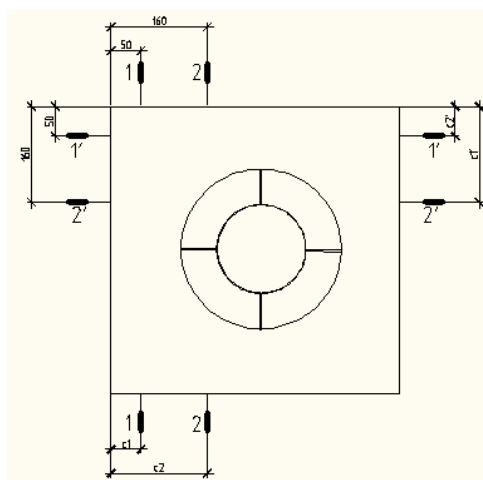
Схема к расчету армирования плитной части фундамента
